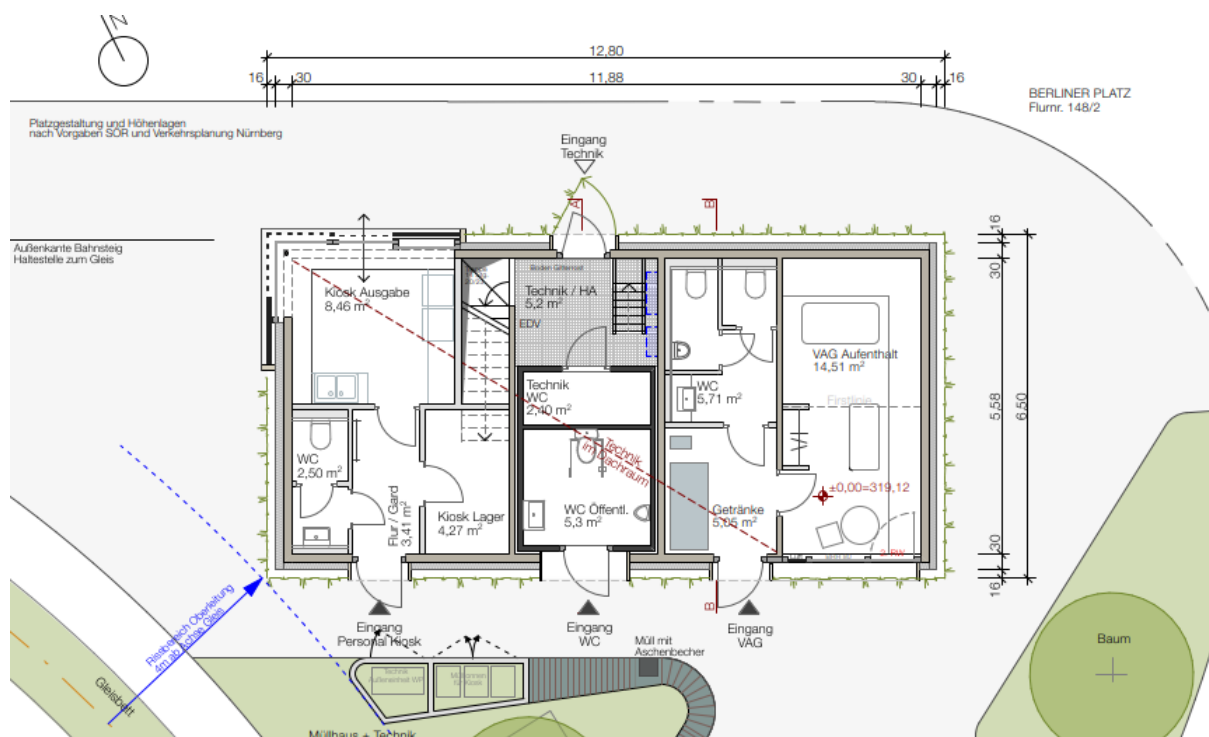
Abmessungen und Grundriss Endhaltestellengebäude (Unterlage 16.1)
